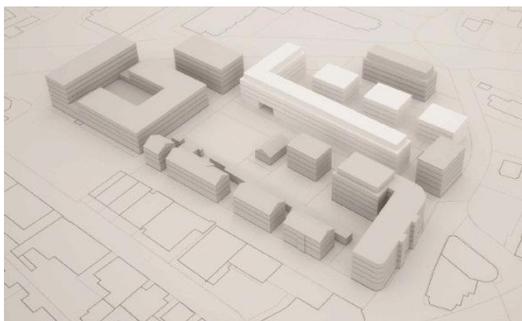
VARIANTE 2 (SOURCE: ARCHITRAM)
